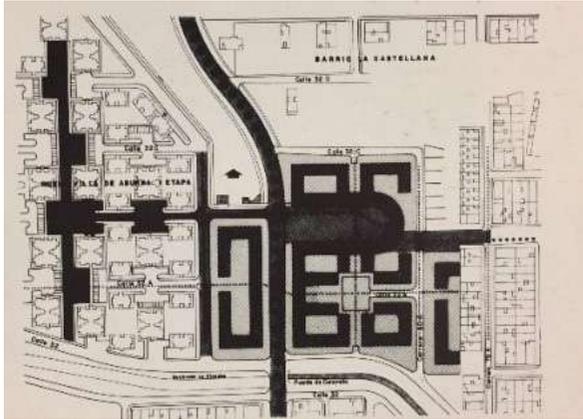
Nueva Villa de Aburrá Fuente: Planta general del proyecto
